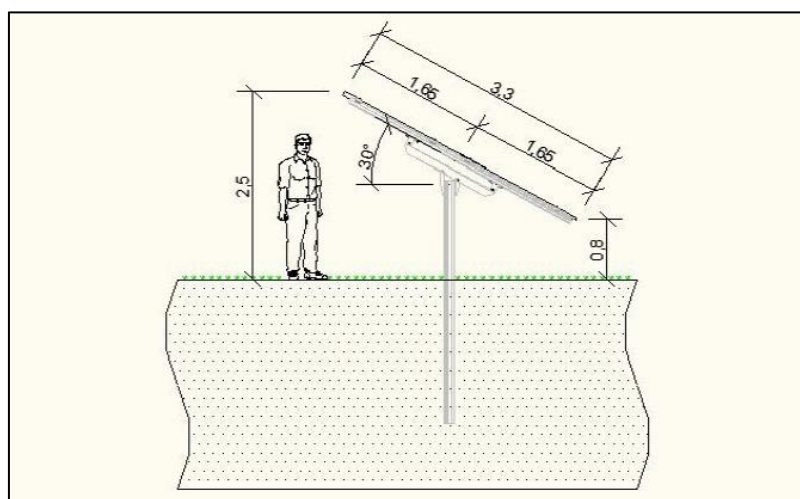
Schéma de construction type (Source : document interne à l'entreprise)
